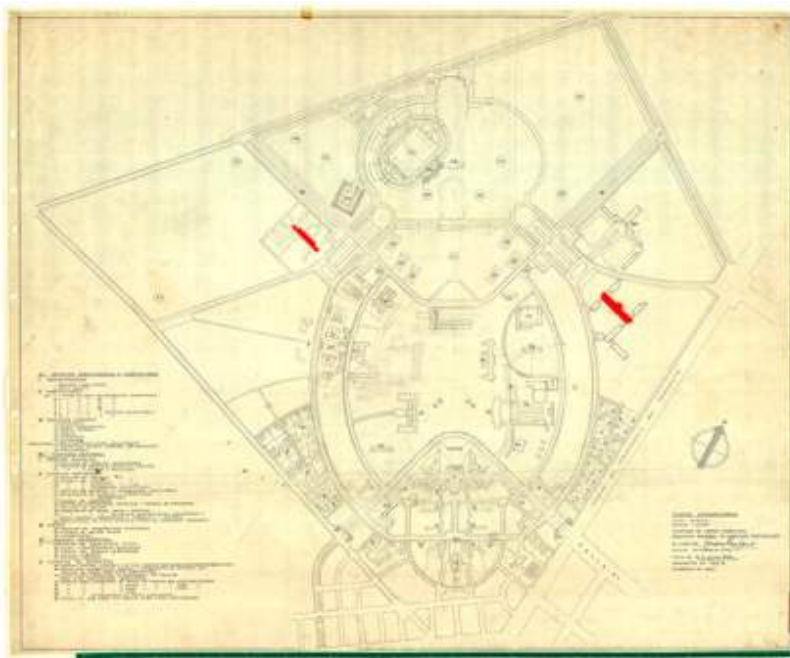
Plano general del campus fechado en septiembre de 1942. Archivo General de la Nación. Colombia. Sección Mapas y Planos. Mapoteca Invías. Plano 494. En color rojo he destacado el contorno de los edificios citados.
